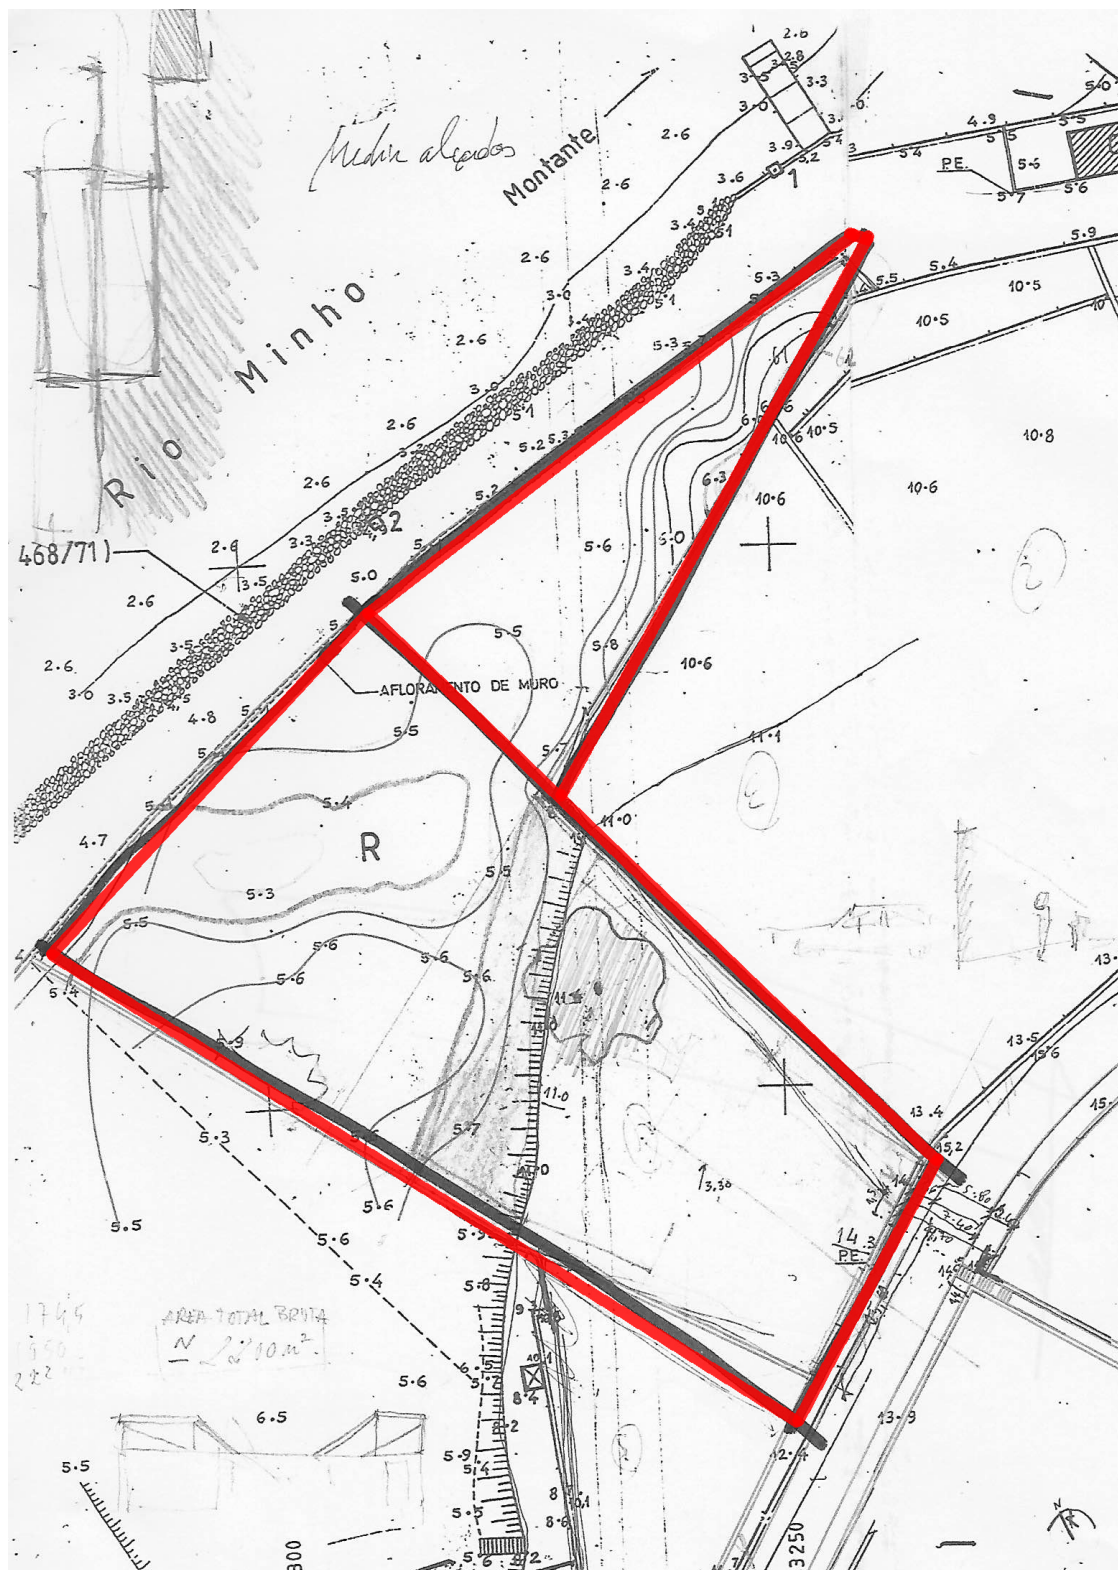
Primeiro contato com a planta existente, geometria do Terreno.
